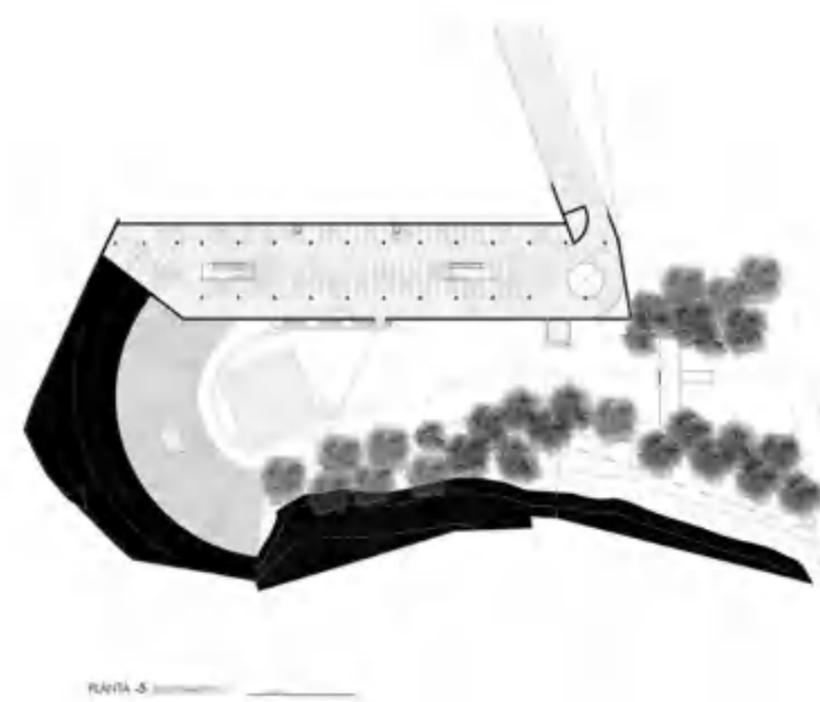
Planta Nivel -5. FONTE: *Archdaily*.
